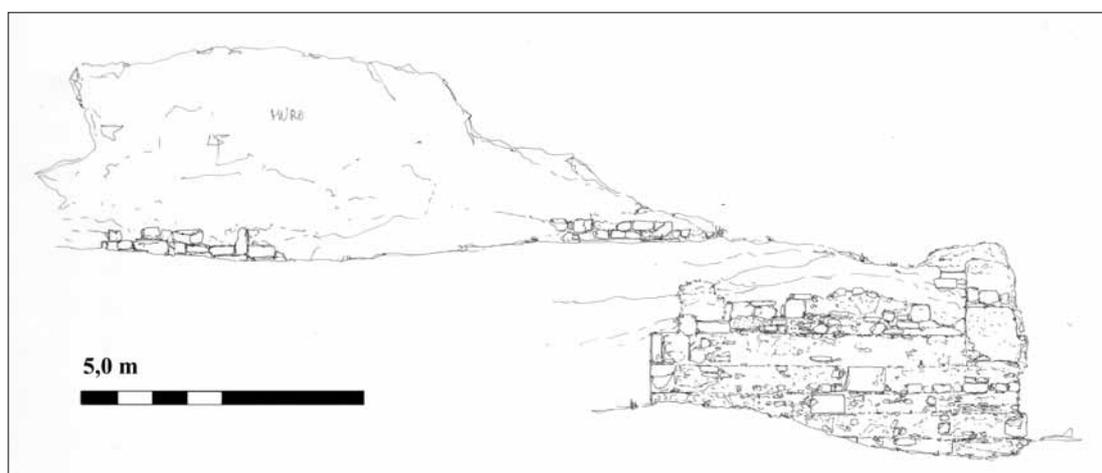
Torre 6.12, prospetto ovest (disegno C. Frigerio).
